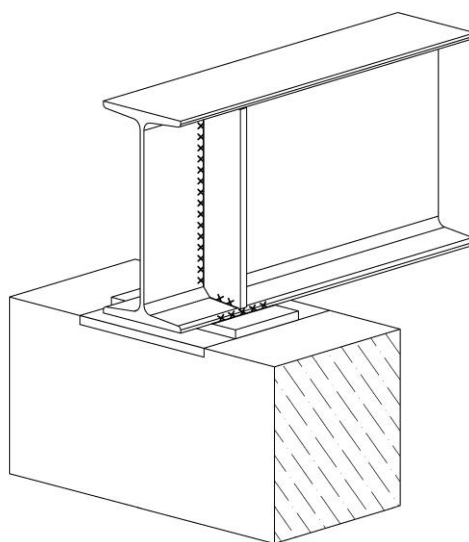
Схема опирания балки перекрытия на кирпичную стену
